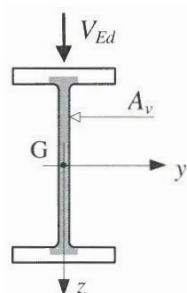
Área de corte de uma secção transversal em I (adaptado de [32])
